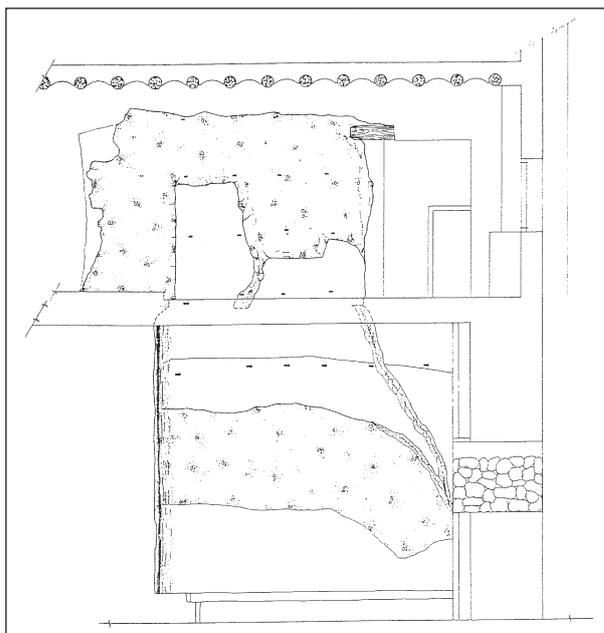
Torre nº 1. Alzado Sur, planta baja y primera planta.
